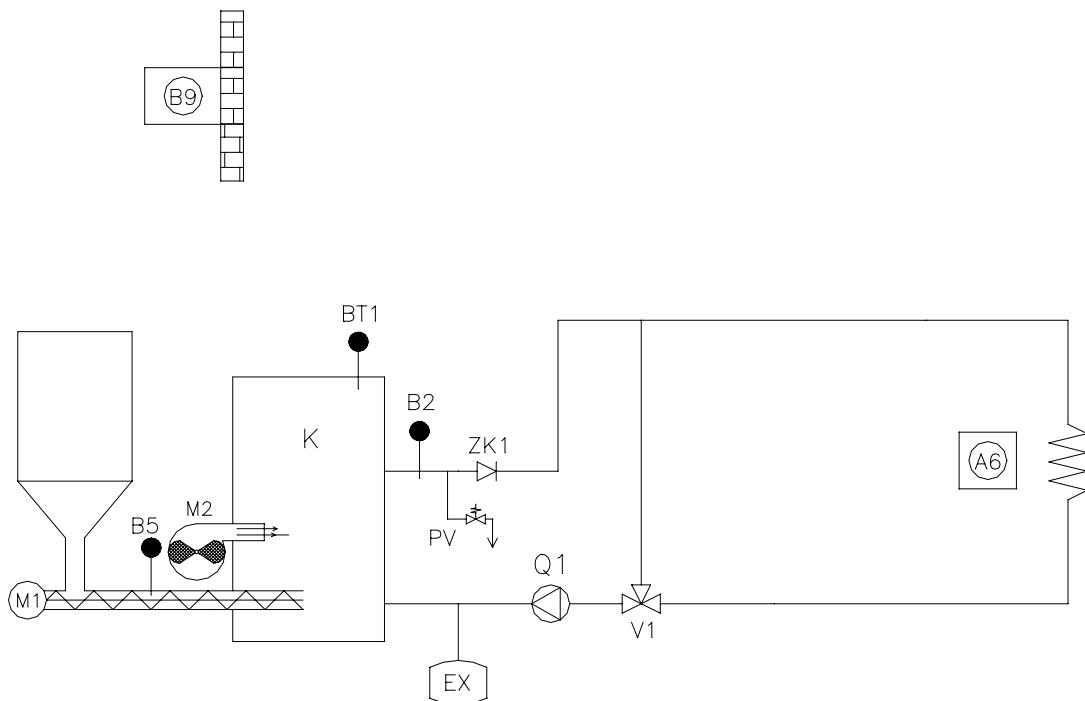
Гидравлическая схема без нагрева теплой воды – отопительный контур с насосами
